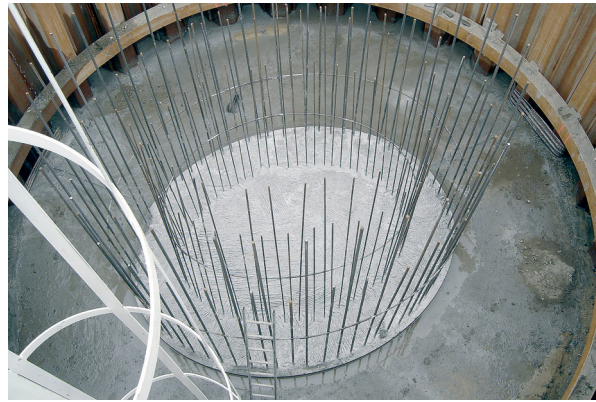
ferrailage longitudinal d'un fût de pile en rivière
